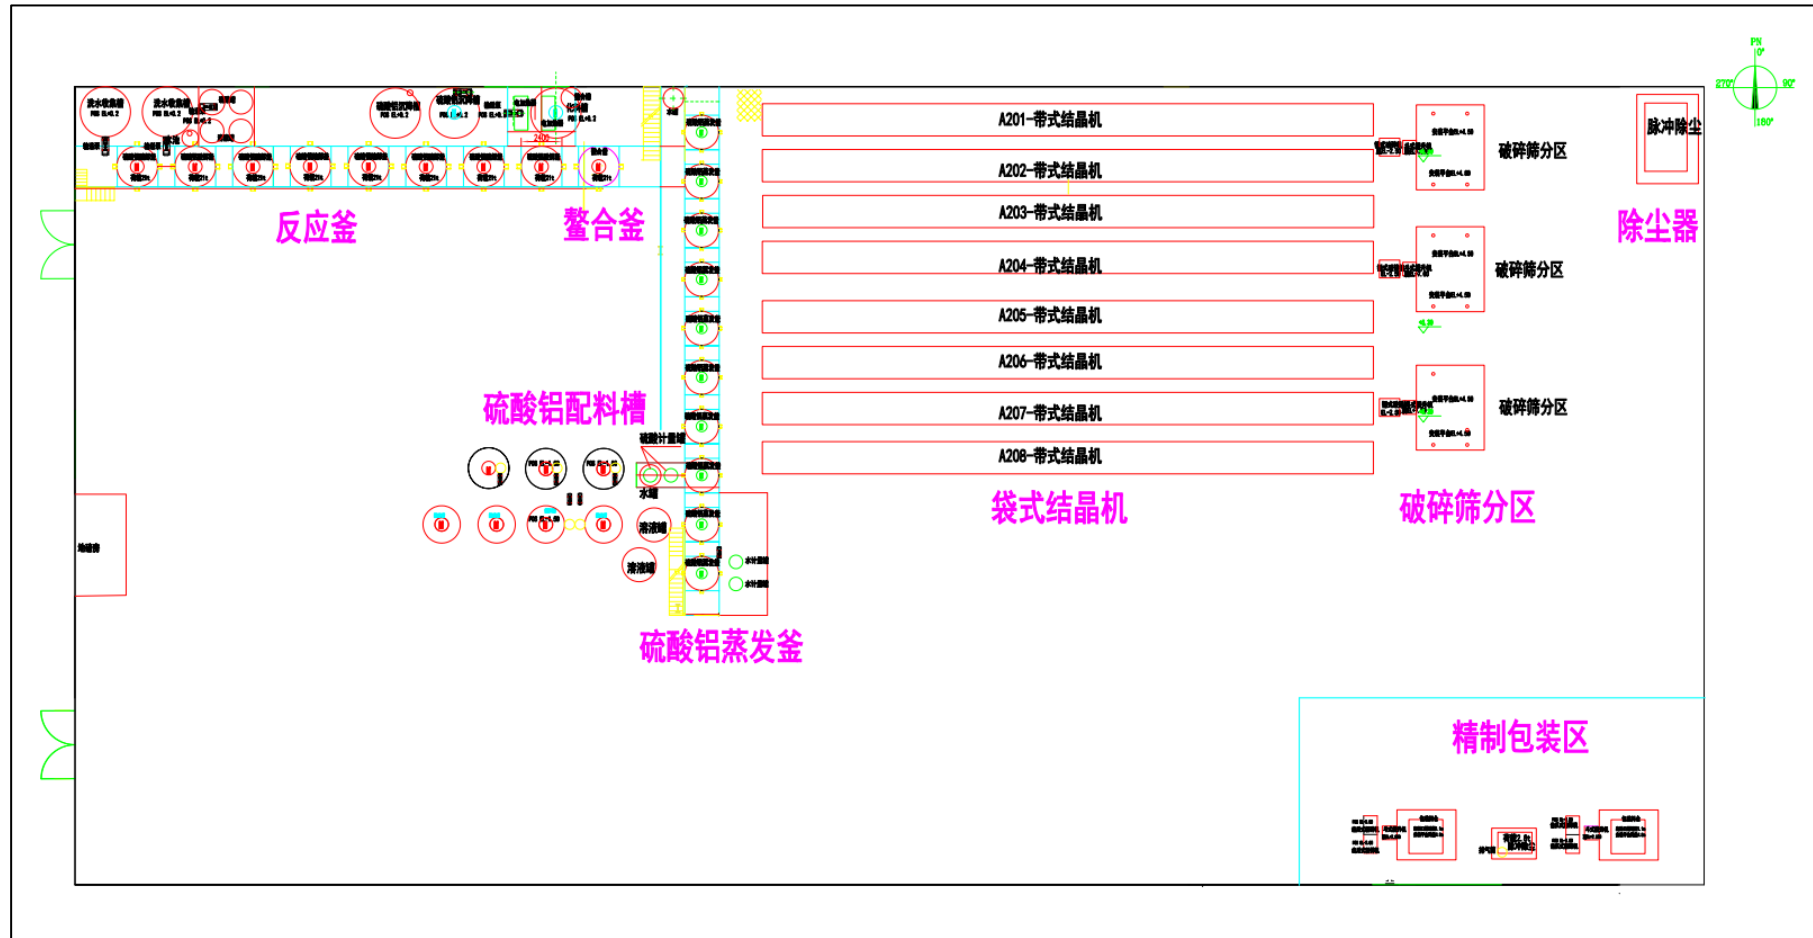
A 废催化剂综合利用车间平面布置图（实际建设）
